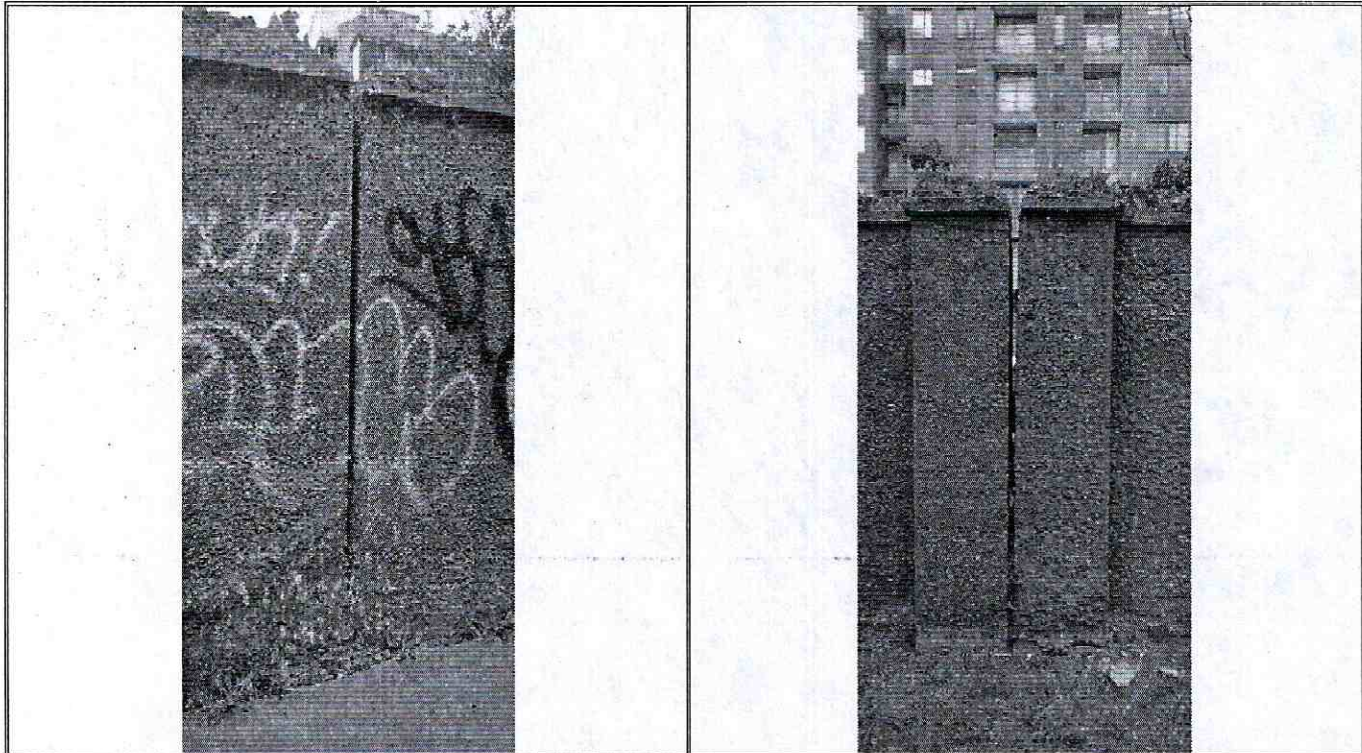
y 8. Presencia de fisuras en el muro evaluado
